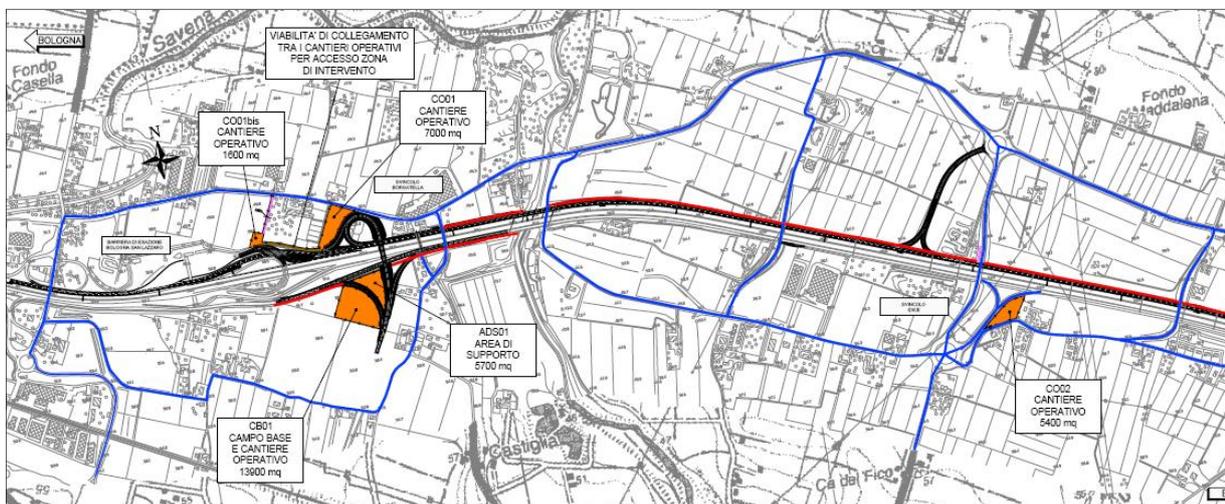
Planimetria generale con localizzazione delle aree di cantiere e le relative viabilità
